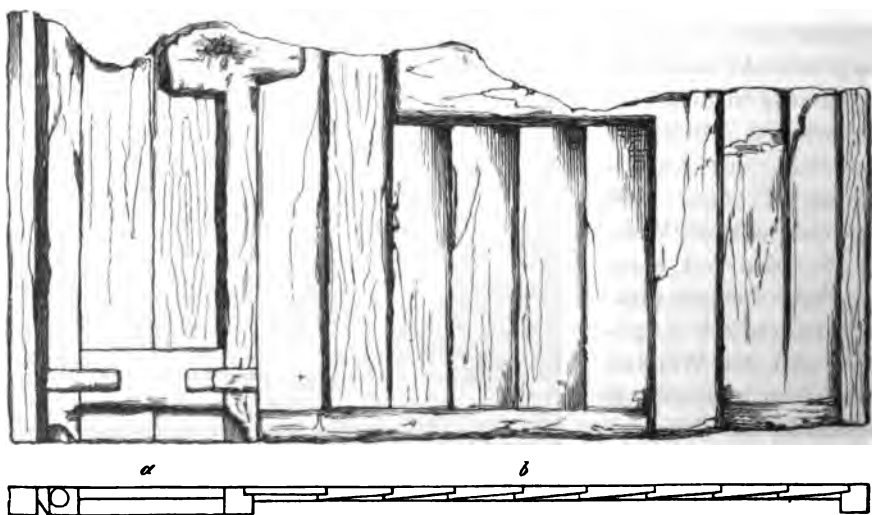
Plan und Ansicht eines Ladenverschlusses.
